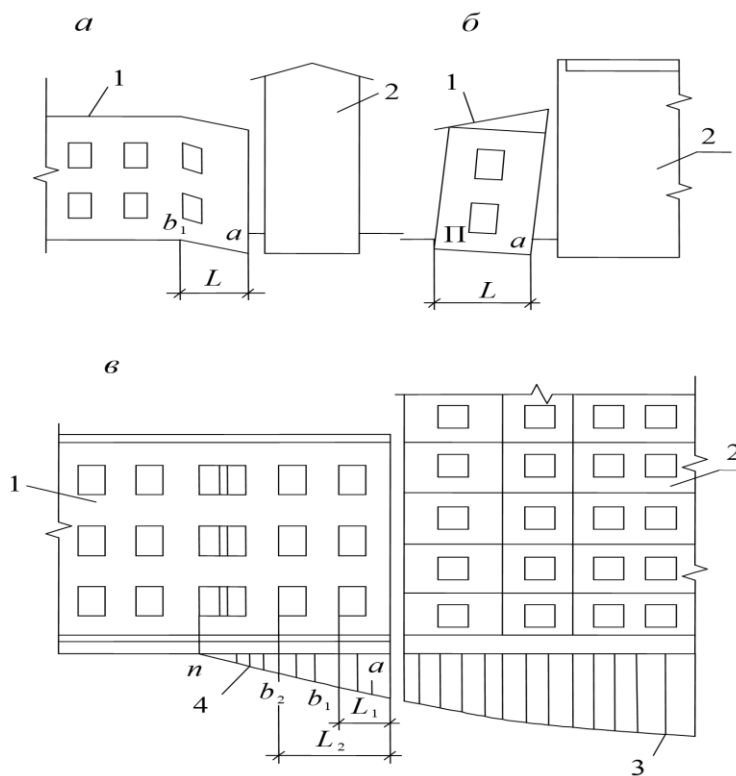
Схема визначення крену будівлі і перекосу його конструкцій в результаті розвитку додаткової осади: а – перекіс конструкцій будівлі; б – крен щодо споруджуваної будівлі; в – епюра осаду поздовжньої стіни нової будівлі і додаткового осаду існуючої будівлі; 1 – існуюча будівля; 2 – яка будується; 3 – крива осаду нової будівлі; 4 – крива додаткового осаду старої будівлі від нової будівлі-прибудови
